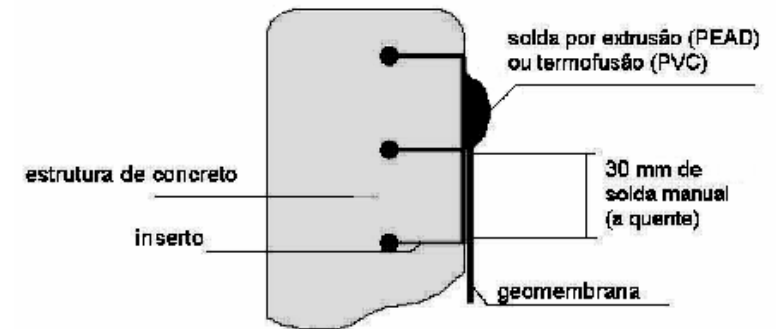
Exemplo de ancoragem de geomembrana em estrutura de concreto.
